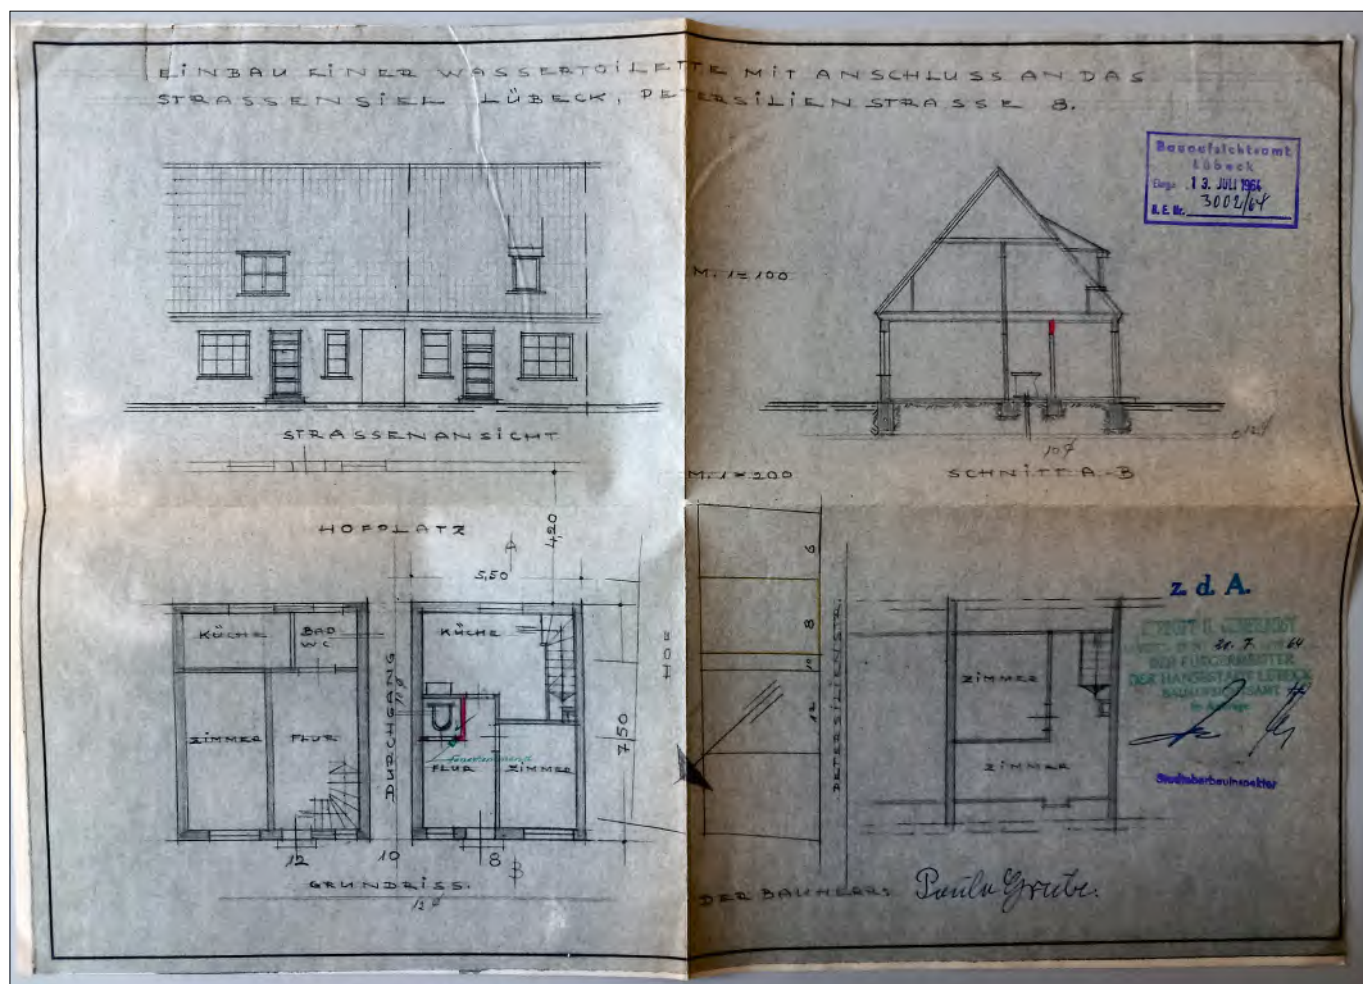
Lübeck, Petersilienstr. 8, Bauplan aus den 1960er Jahren (Einbau einer Wassertoilette) mit Ansicht der Fassade in dreiteiliger Gliederung – HL/Bauaktenarchiv/1964.
